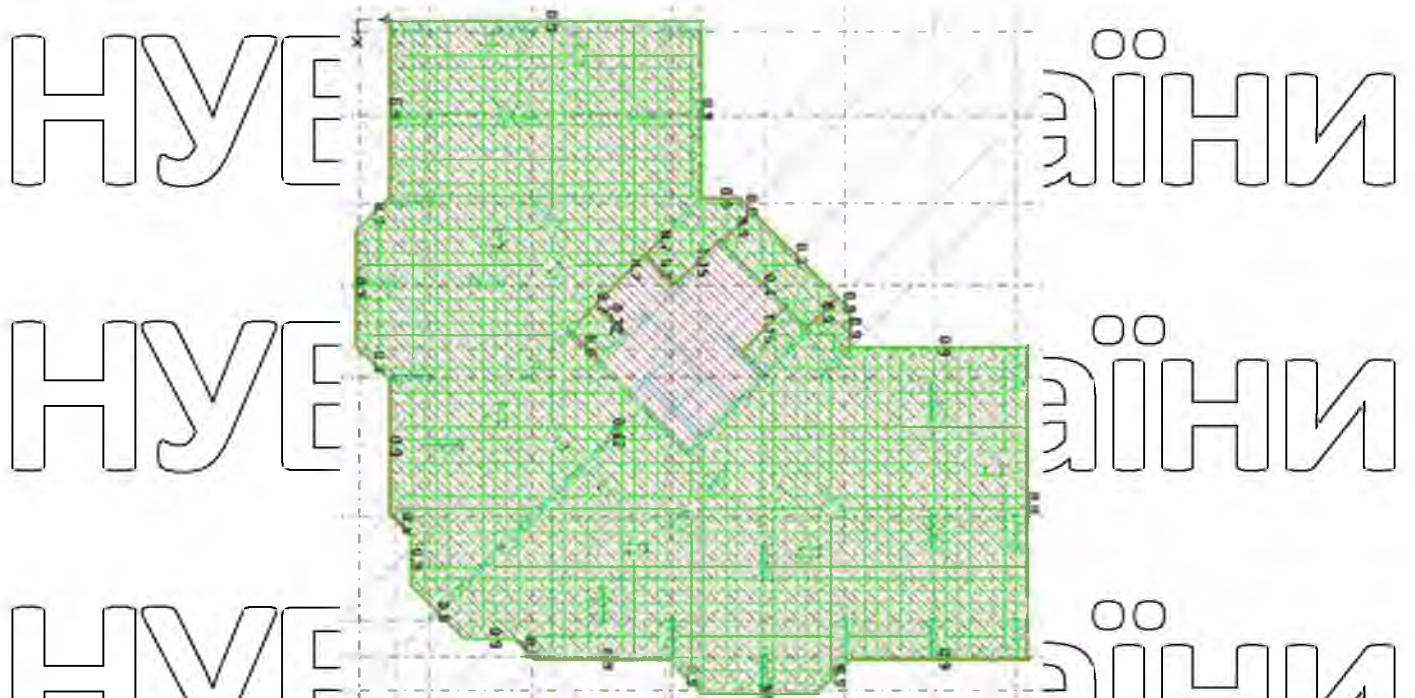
Розрахункова схема МСЕ типової плити і перекриття секція А-А
